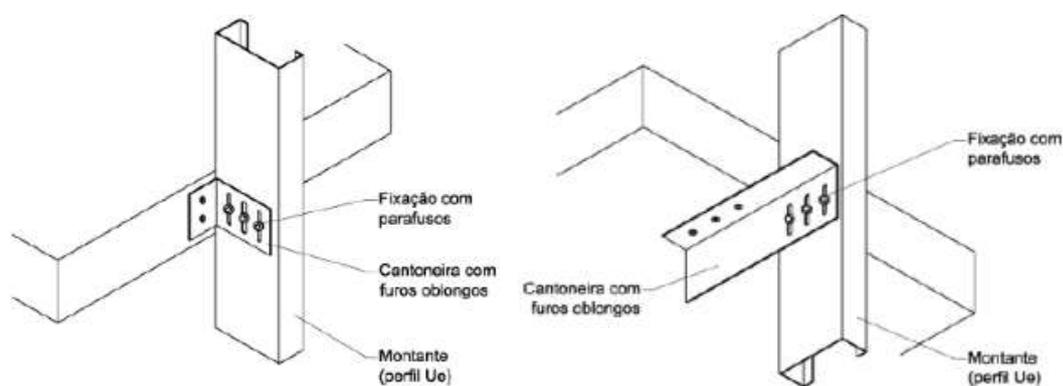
e 3 – Ligações rígidas com cantoneiras comum e de aba longa
